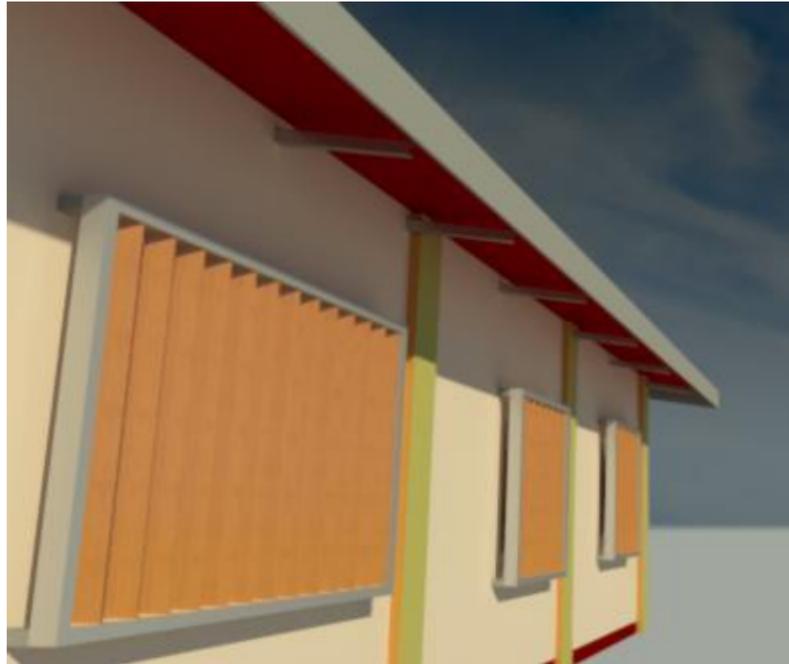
Fachada exterior noroeste, uso de EPS diseñado según fachada. Realizado por autoras.
